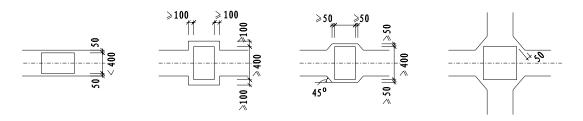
现浇柱与条形基础梁交接处平面尺寸
